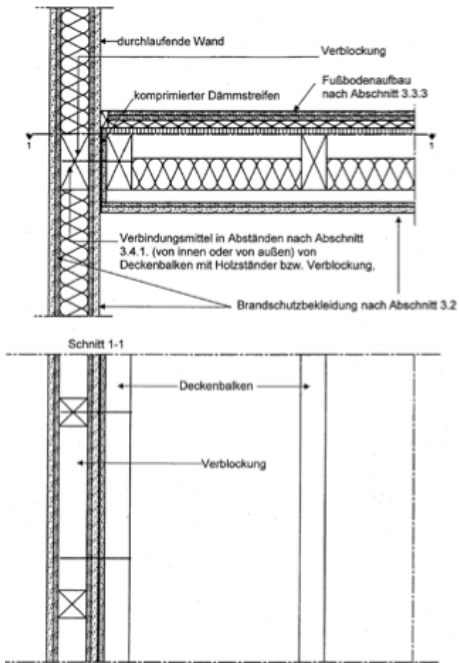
Anschluss Decke an durchlaufende raumabschließende Wand nach der M-HFH-HolzR (Treppenraumwand, Außenwand, auch nicht-tragend- Spannrichtung der Deckenbalken senkrecht zur Wand)
